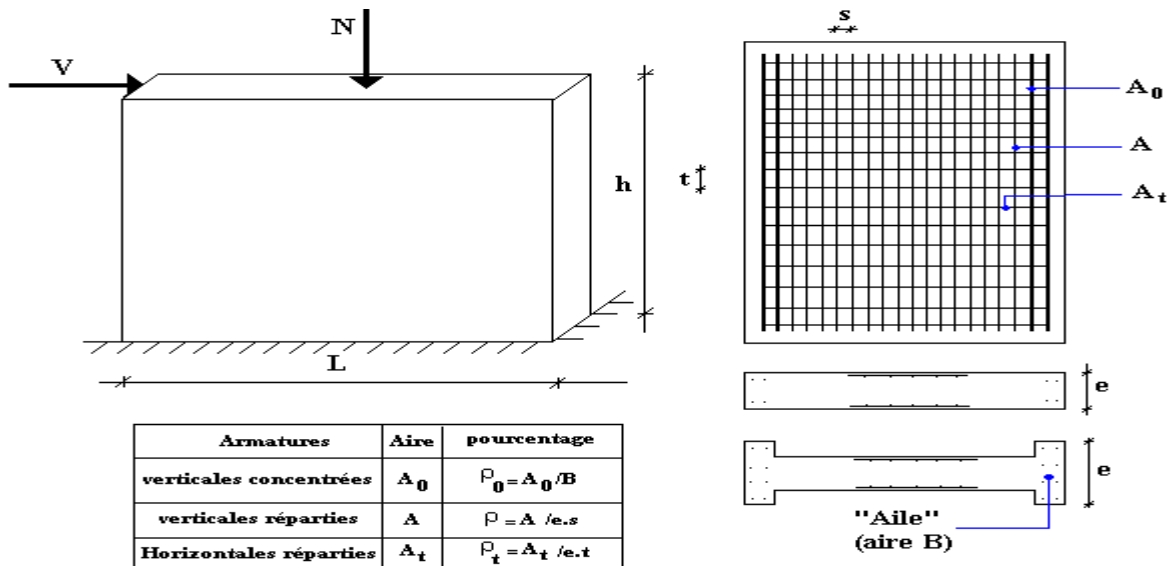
Schéma d'un voile plein et disposition du ferrailage
